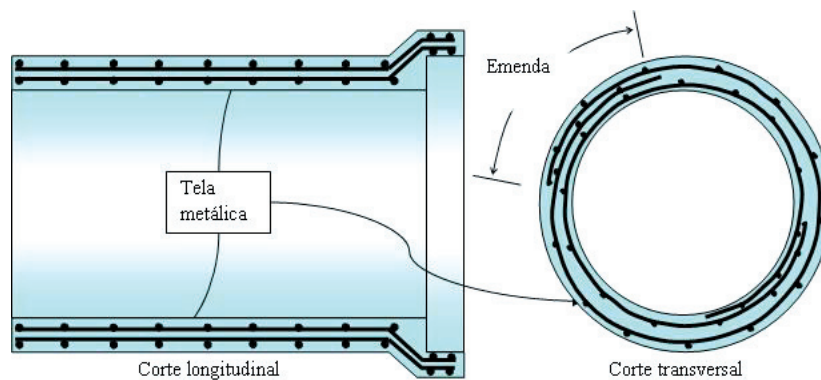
Posicionamento de armadura dupla com tela soldada em um tubo com ponta e bolsa
